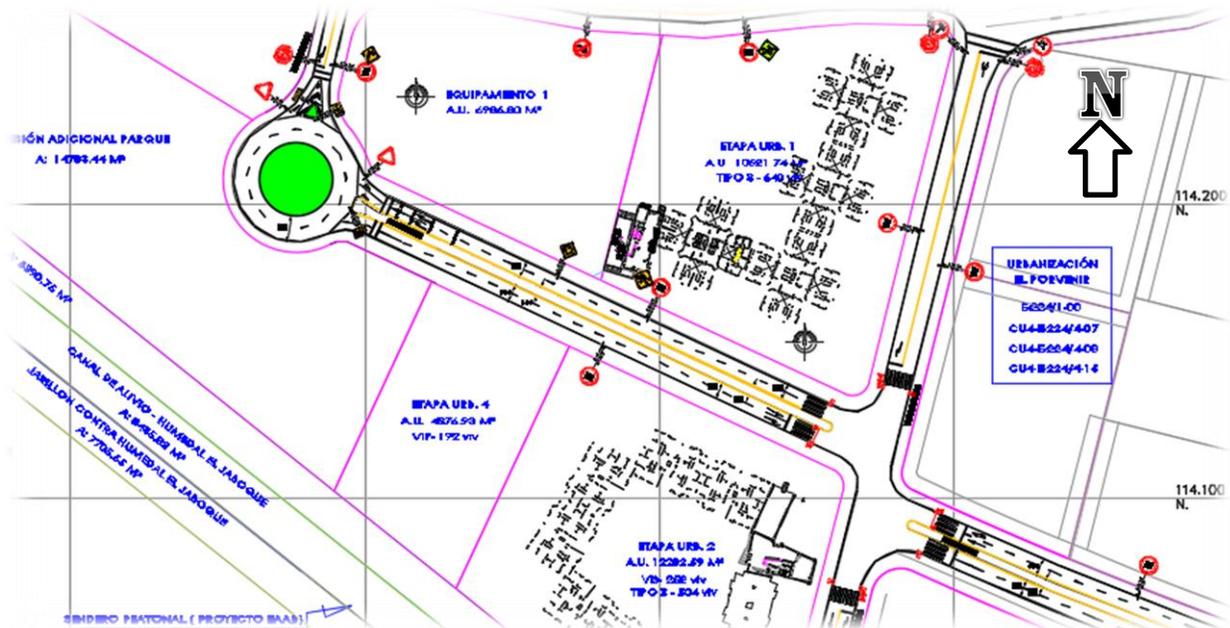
Planteamiento inicial para la modificación del Plan Parcial El Porvenir.
